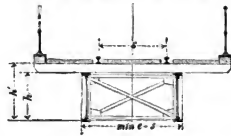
u. 254. Fahrbahn ohne Bettung auf Eisenbahnbrücken. Tiefe Konstruktion.
